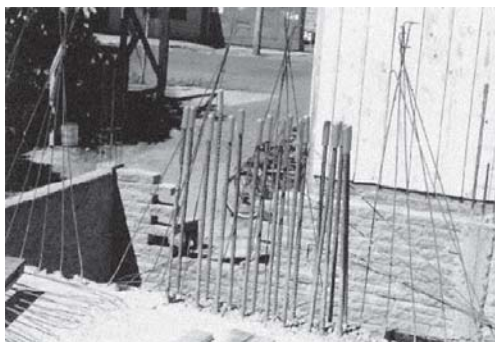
Exemplo de proteção em pontas verticais de ferragens
